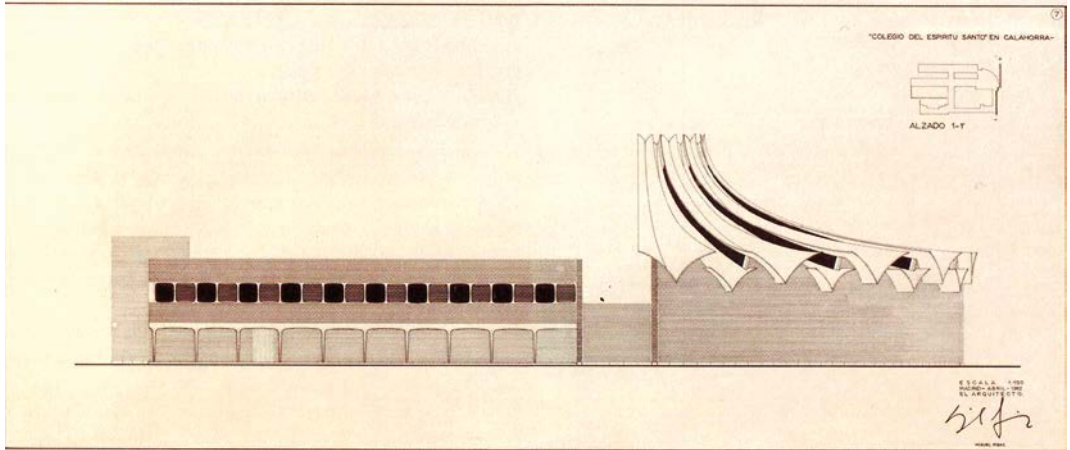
Fachada este. Proyecto. (AFF, sig. 152).
